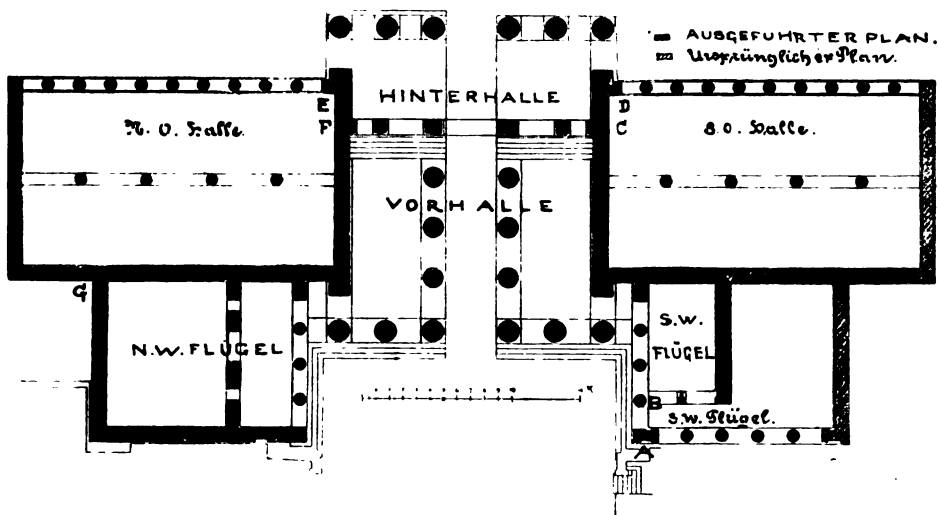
(10). Die Propyläen mit ihren Seitenbauten. Grundriss.
